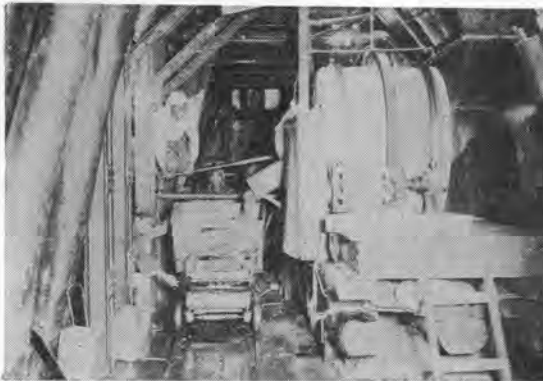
コンクリートミキサ(第1期工事,昭和9年)
